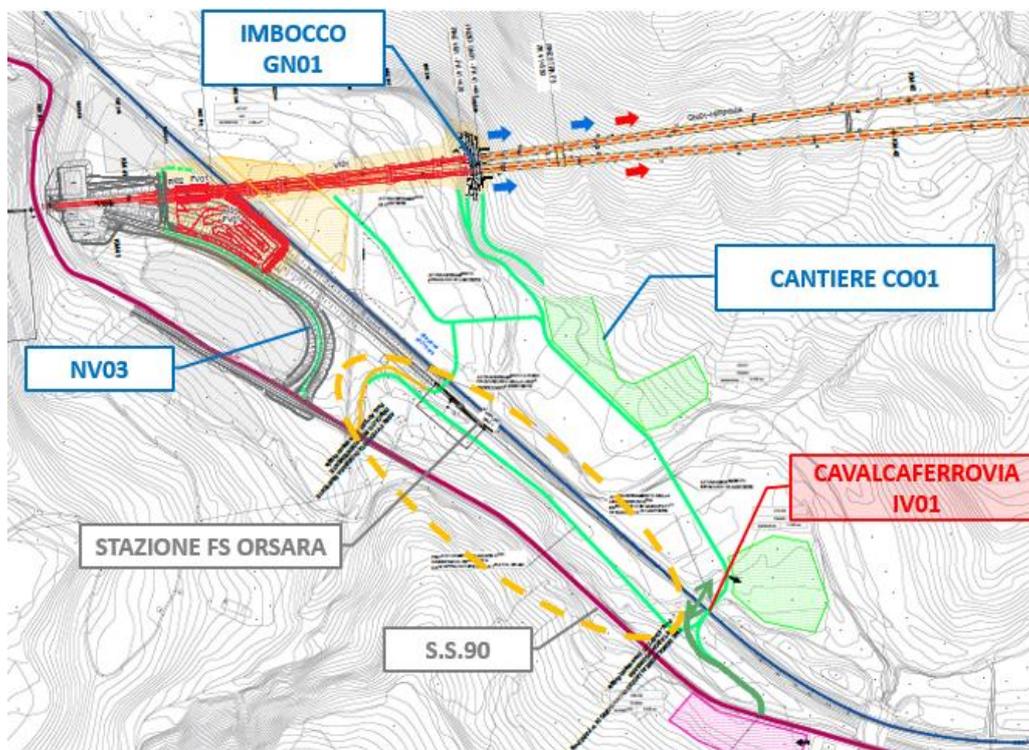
Criticità rilevate nel sistema degli accessi ai cantieri previsto dal PD
